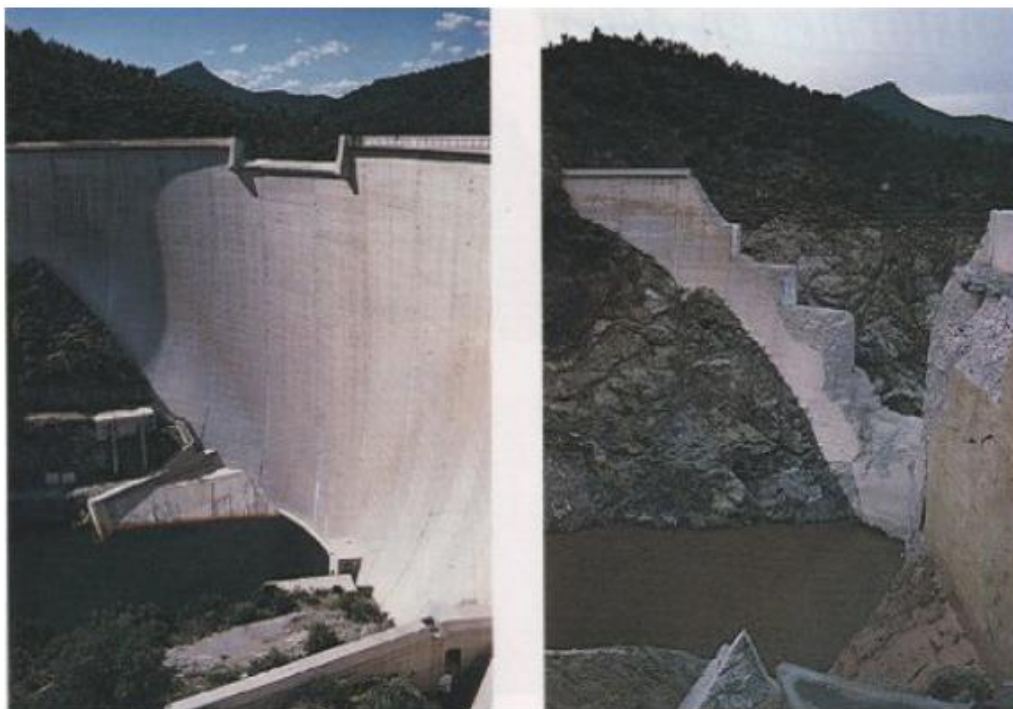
Falha estrutural de uma barragem de concreto, vista antes e depois da ruptura.
